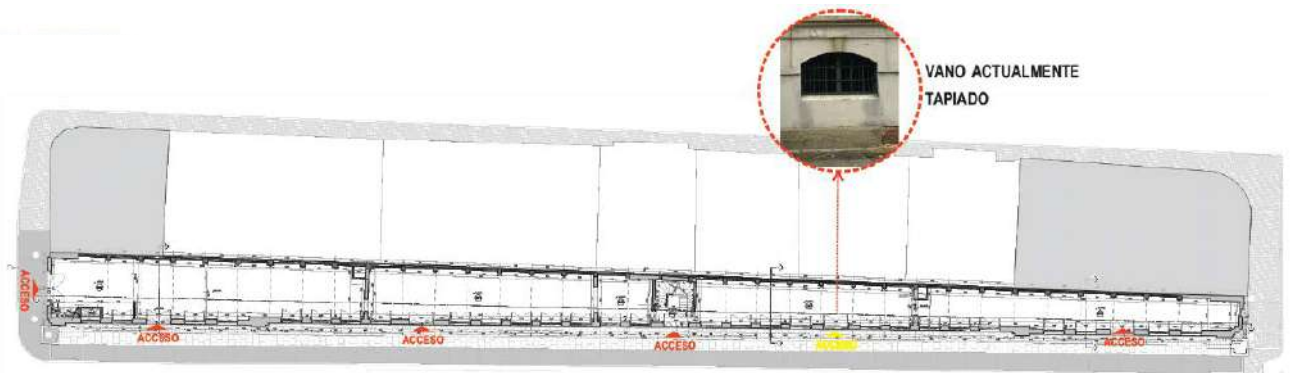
Accesos planta de primer piso edificio "La Flauta"
